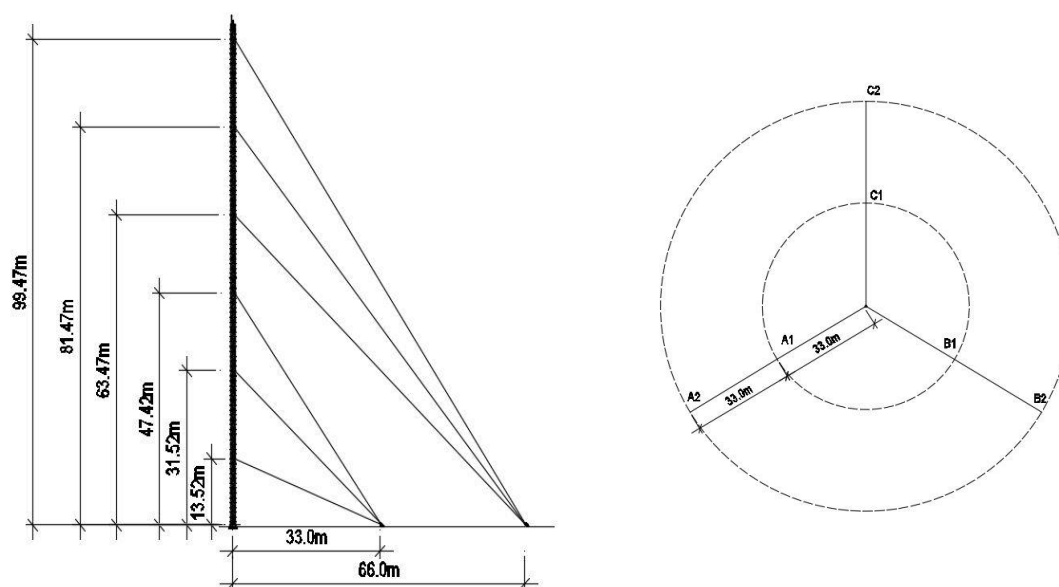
a) Vista en elevación de la torre b) Vista en planta de la torre
